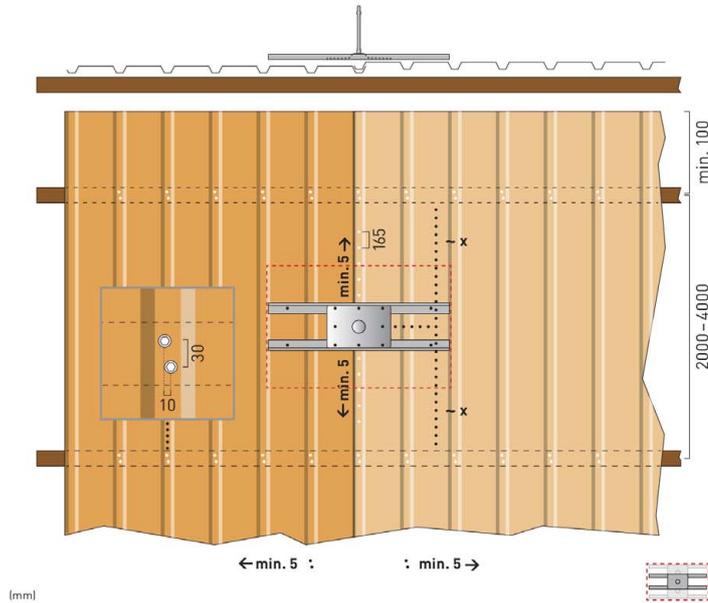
Anschlagseinrichtung PT+ verstärkt auf Stahltrapezprofil in Positivlage
